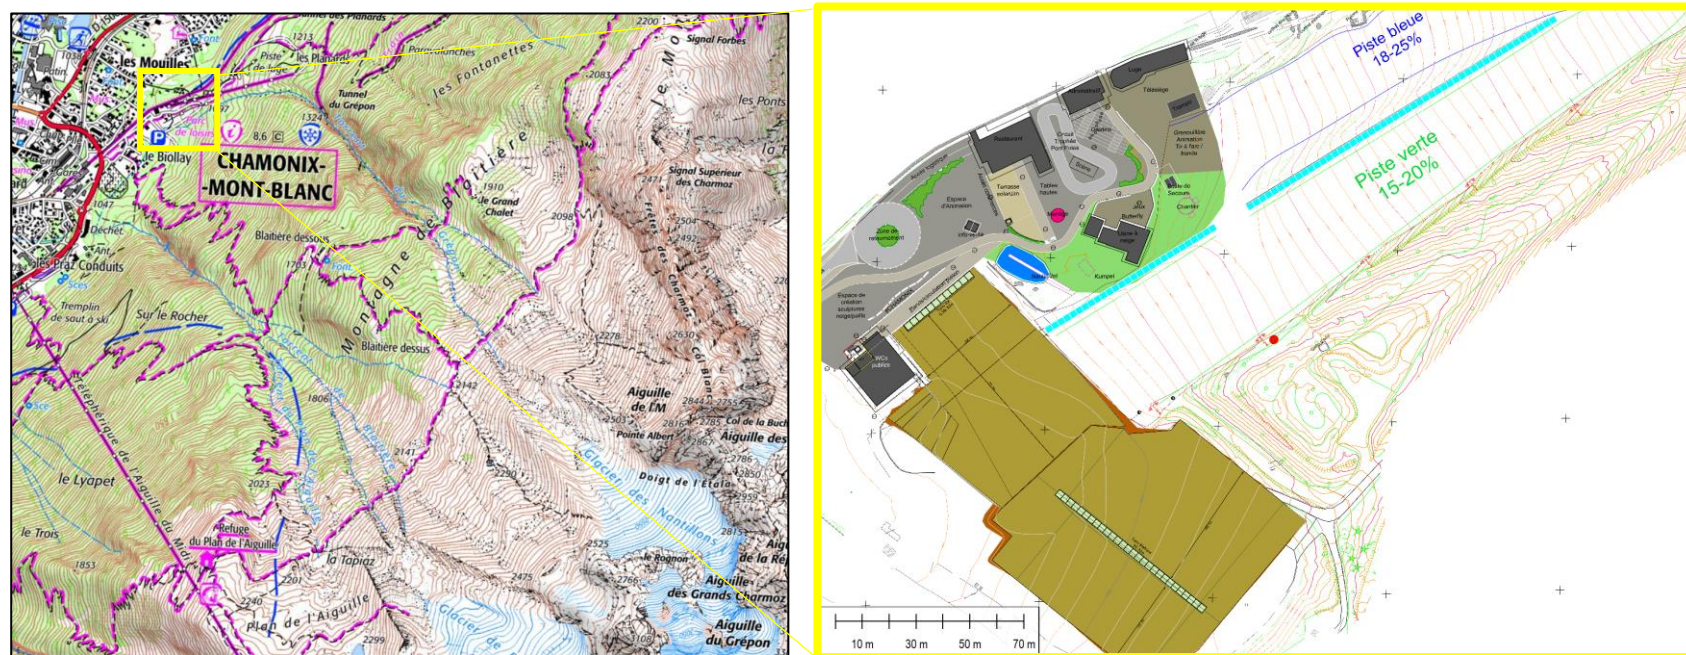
Plan de situation (source Géoportail) et plan du projet [0]
